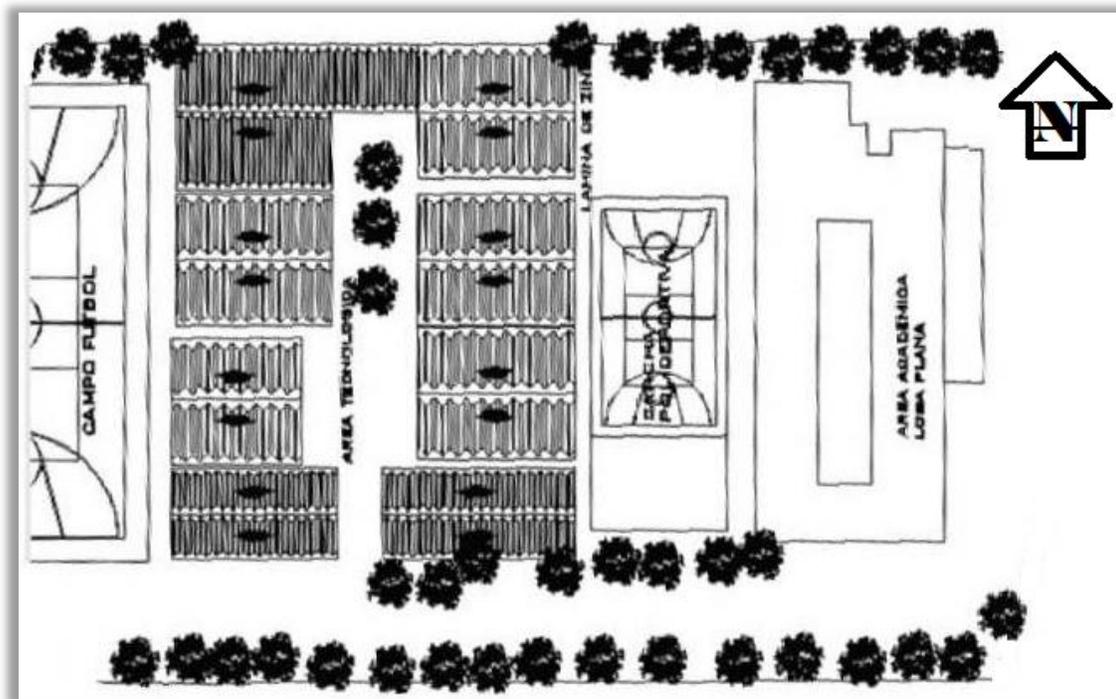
Planta de techos, Instituto Técnico Industrial. Fuente: Elaboración Propia.
